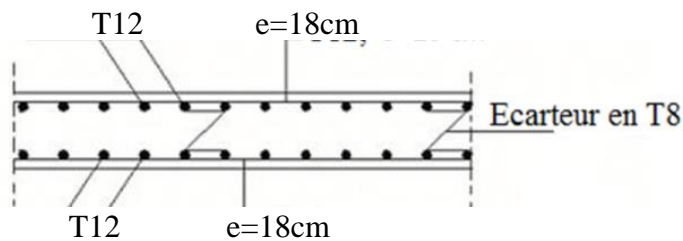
Disposition constructive des armatures de la dalle pleine
